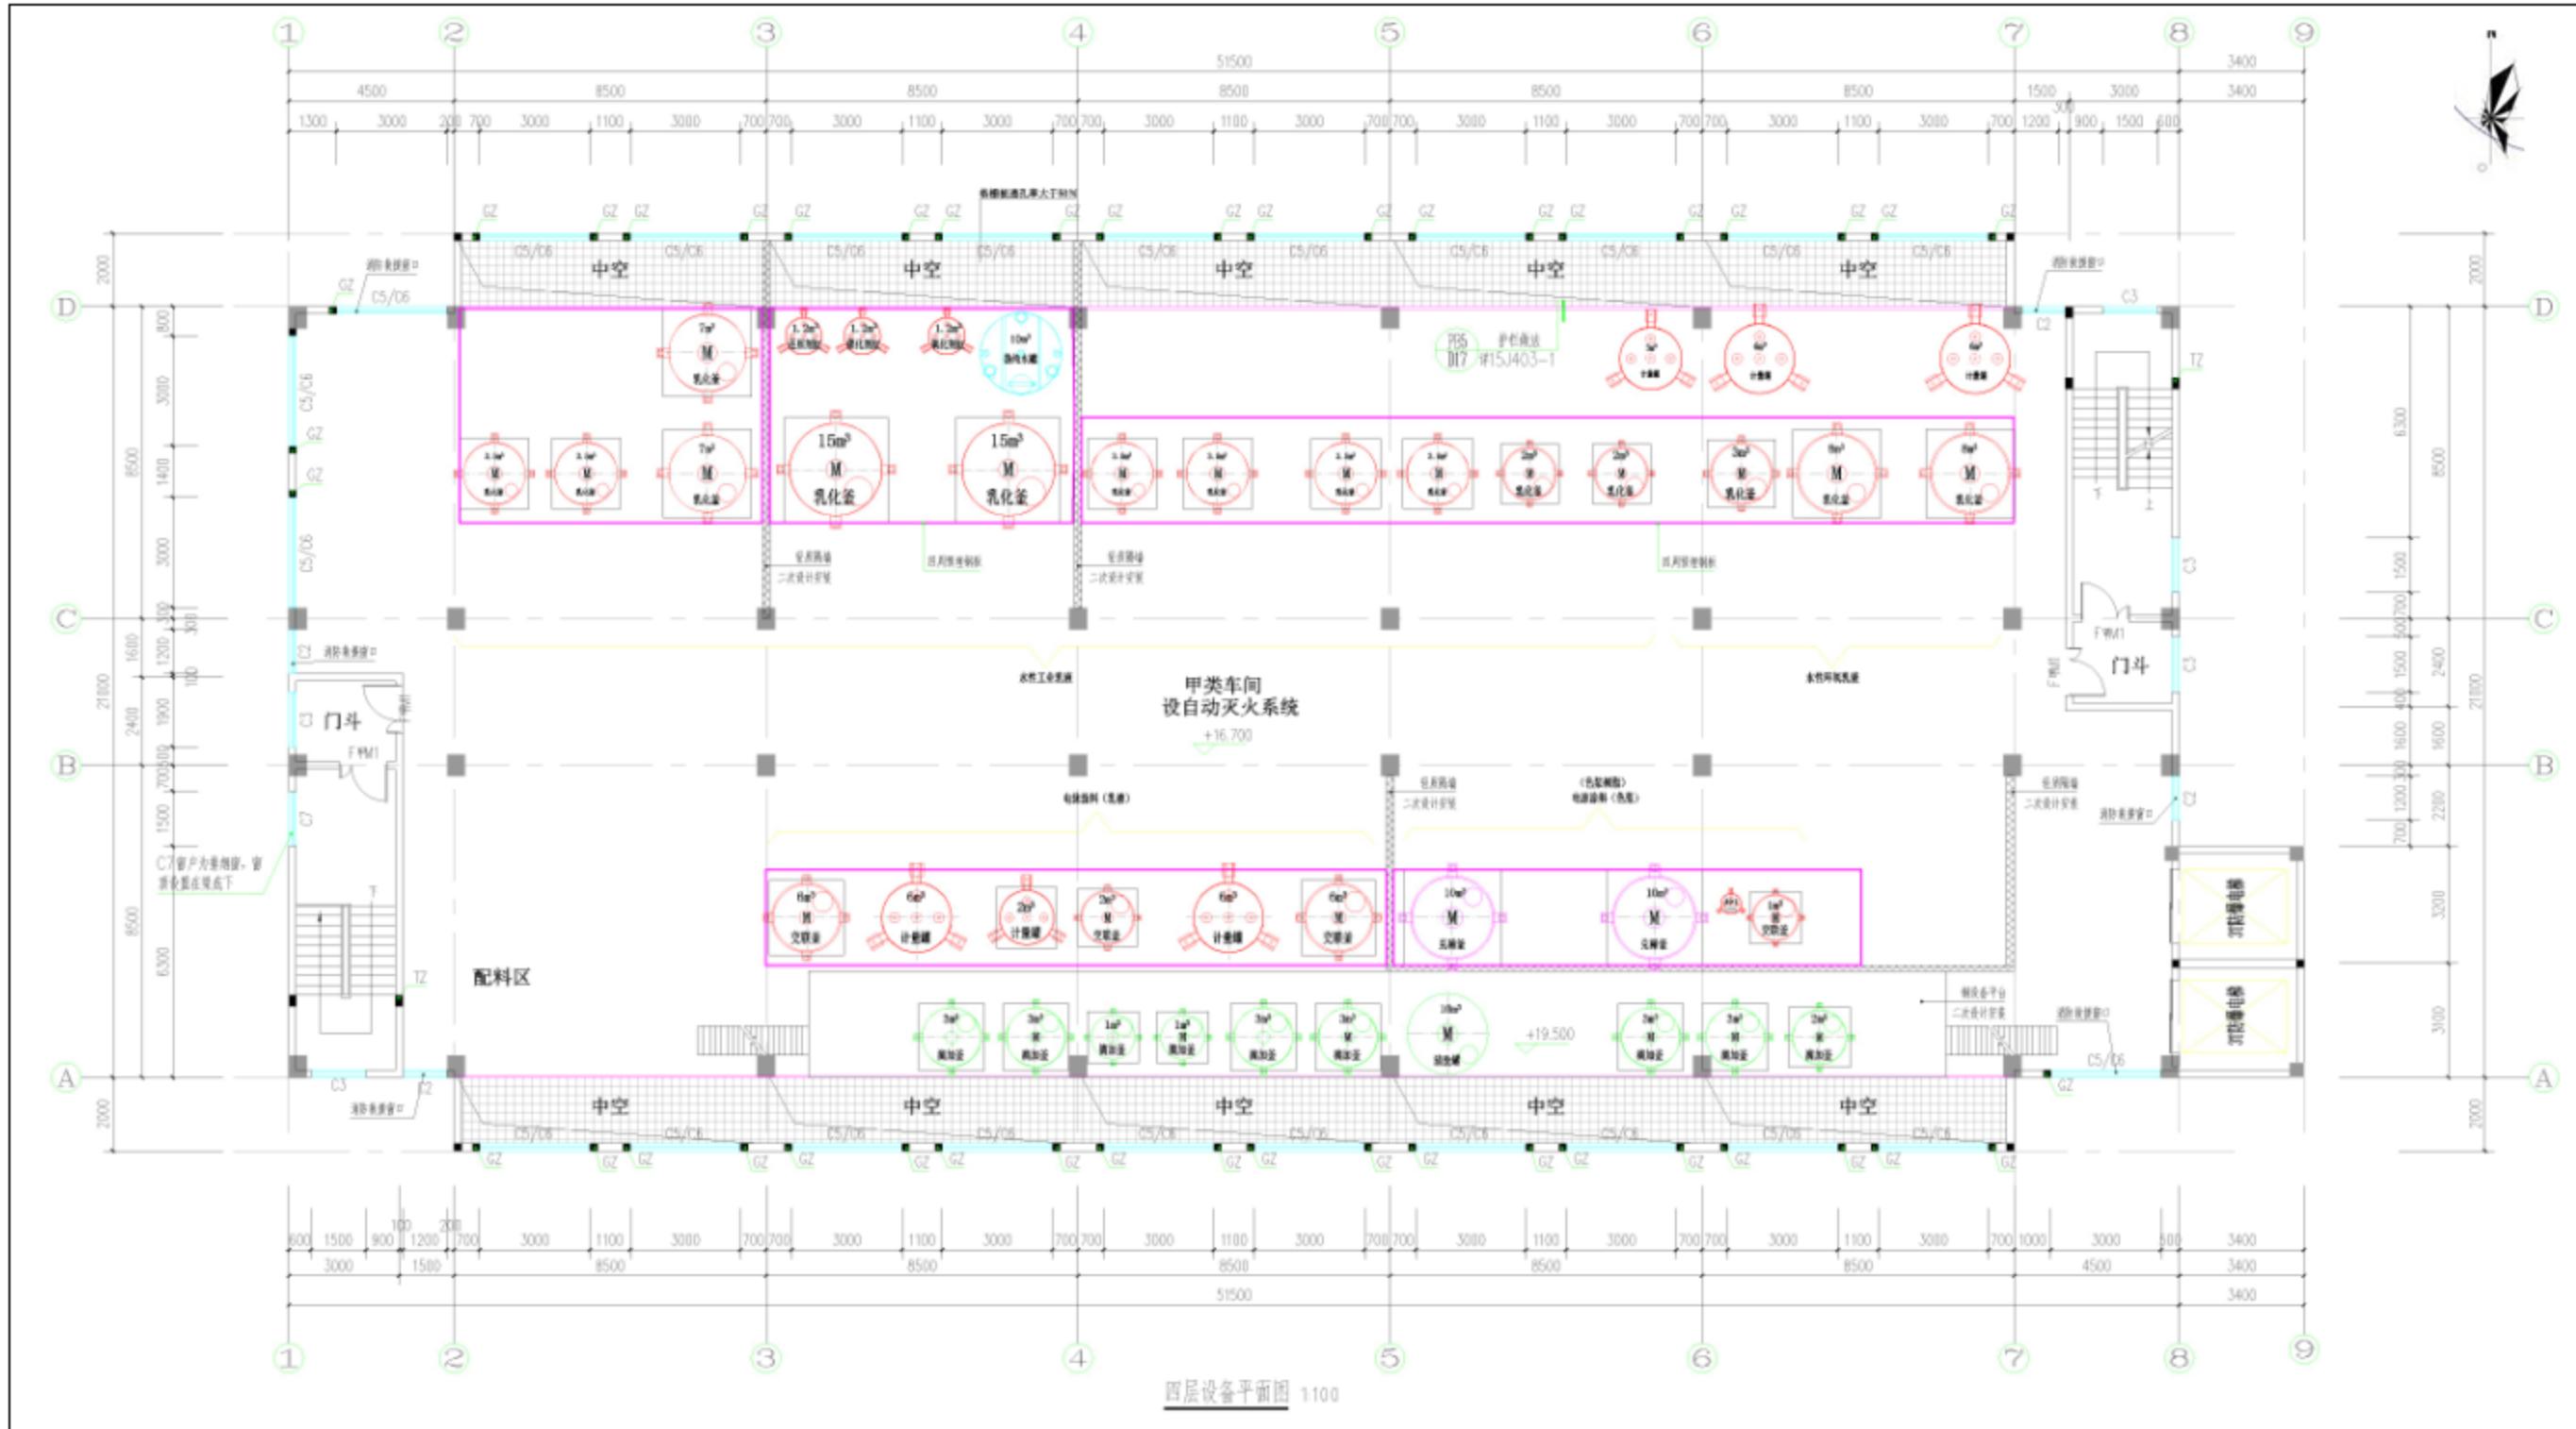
甲类车间C4层平面布置图(比例尺1:100)
